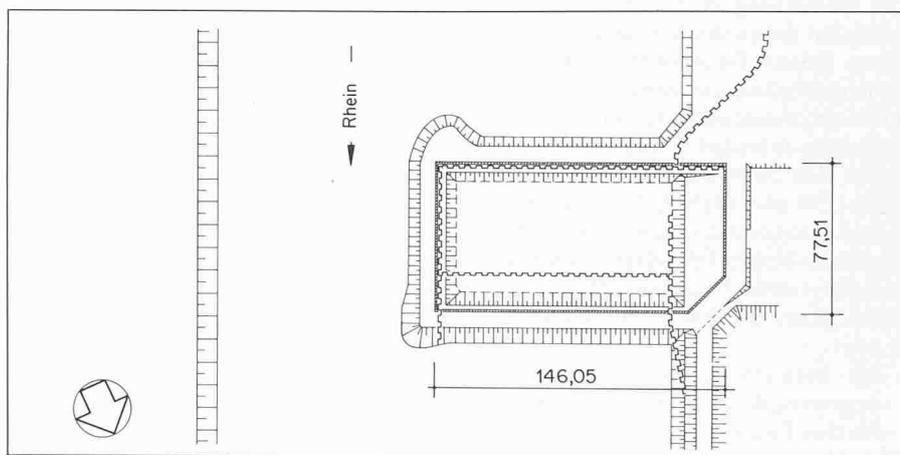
Lageplan mit Baugrube, 1. Bauabschnitt
